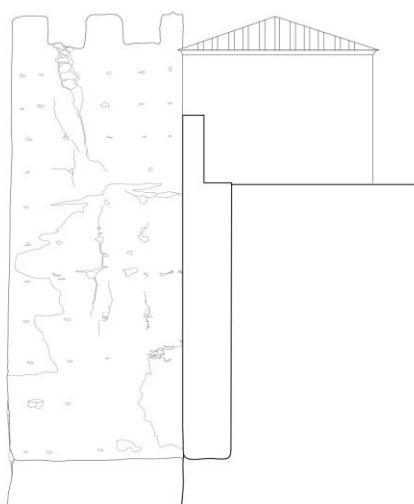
Sección lienzo 3 y lado lateral torre C. Escala 1/200. Fuente: Autora.
